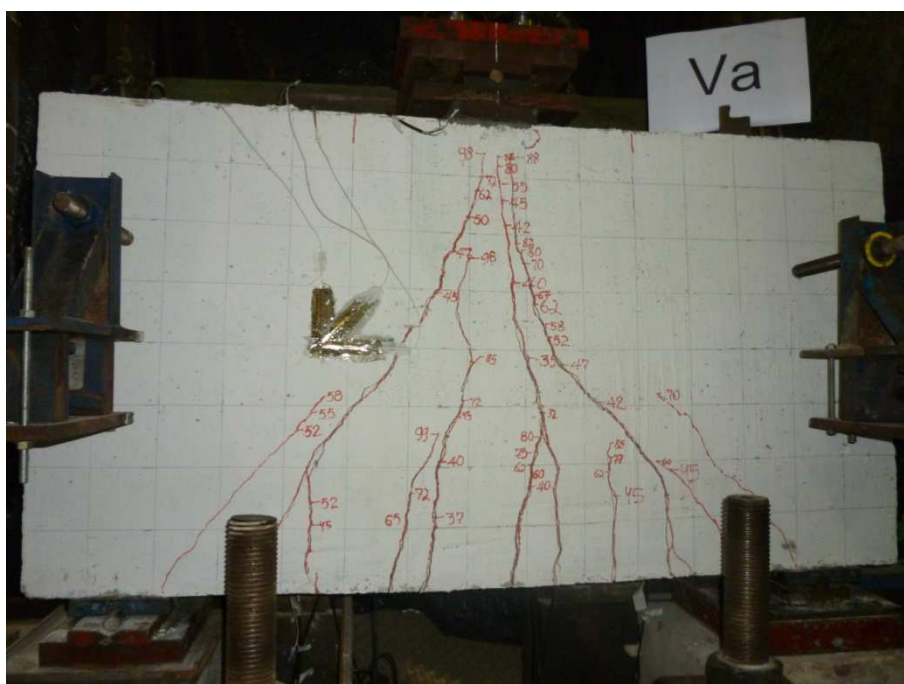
Configuração de fissura - Viga V4.
